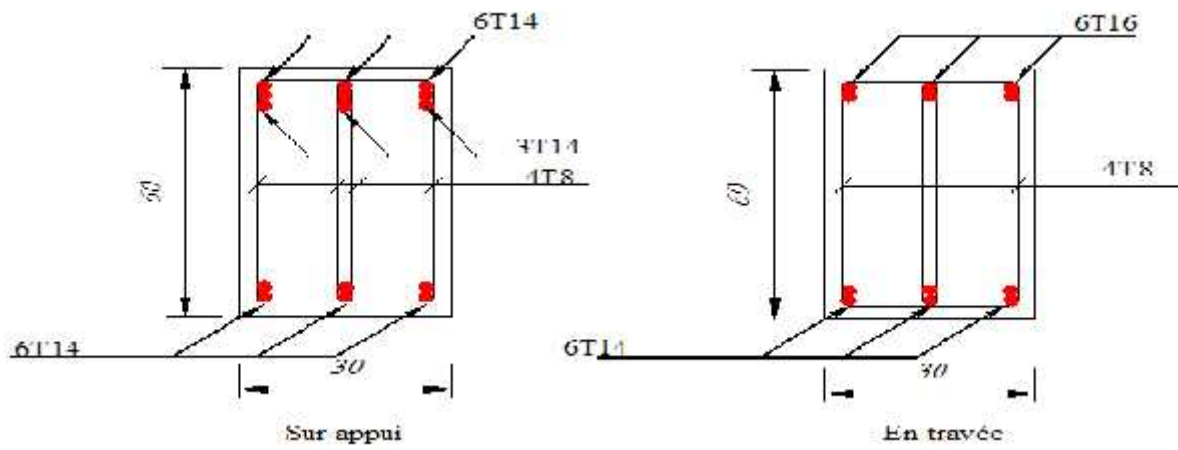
Ferraillage des poutres porteuses troisièmes types.
